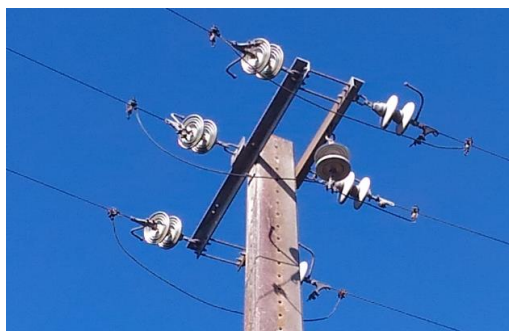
Isoladores inseridos em cadeia de amarração no apoio.
